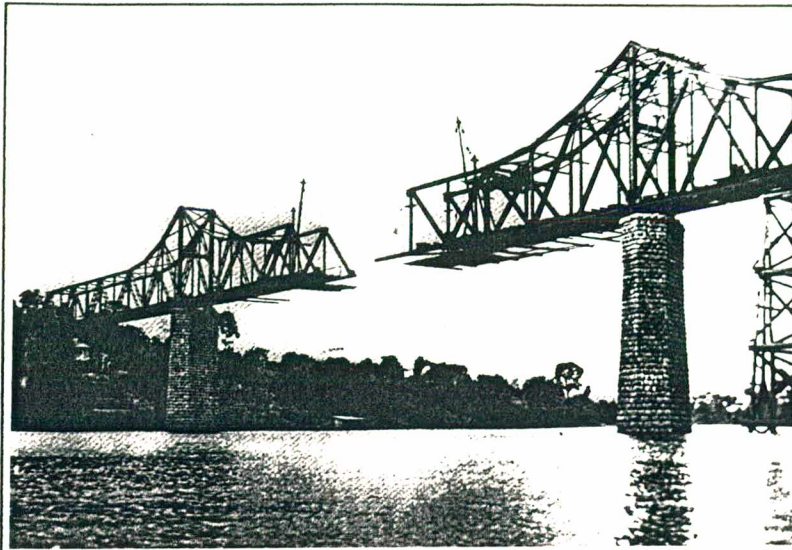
Construção da Ponte da Estrada de Ferro de Blumenau, 1931.
